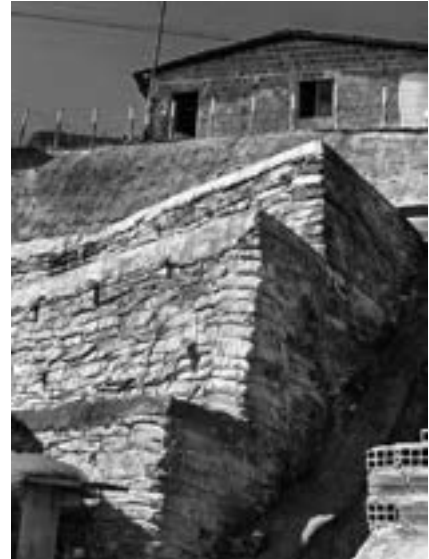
Muro de arrimo em solo-cimento ensacado. (Coutinho et al., 2005)
